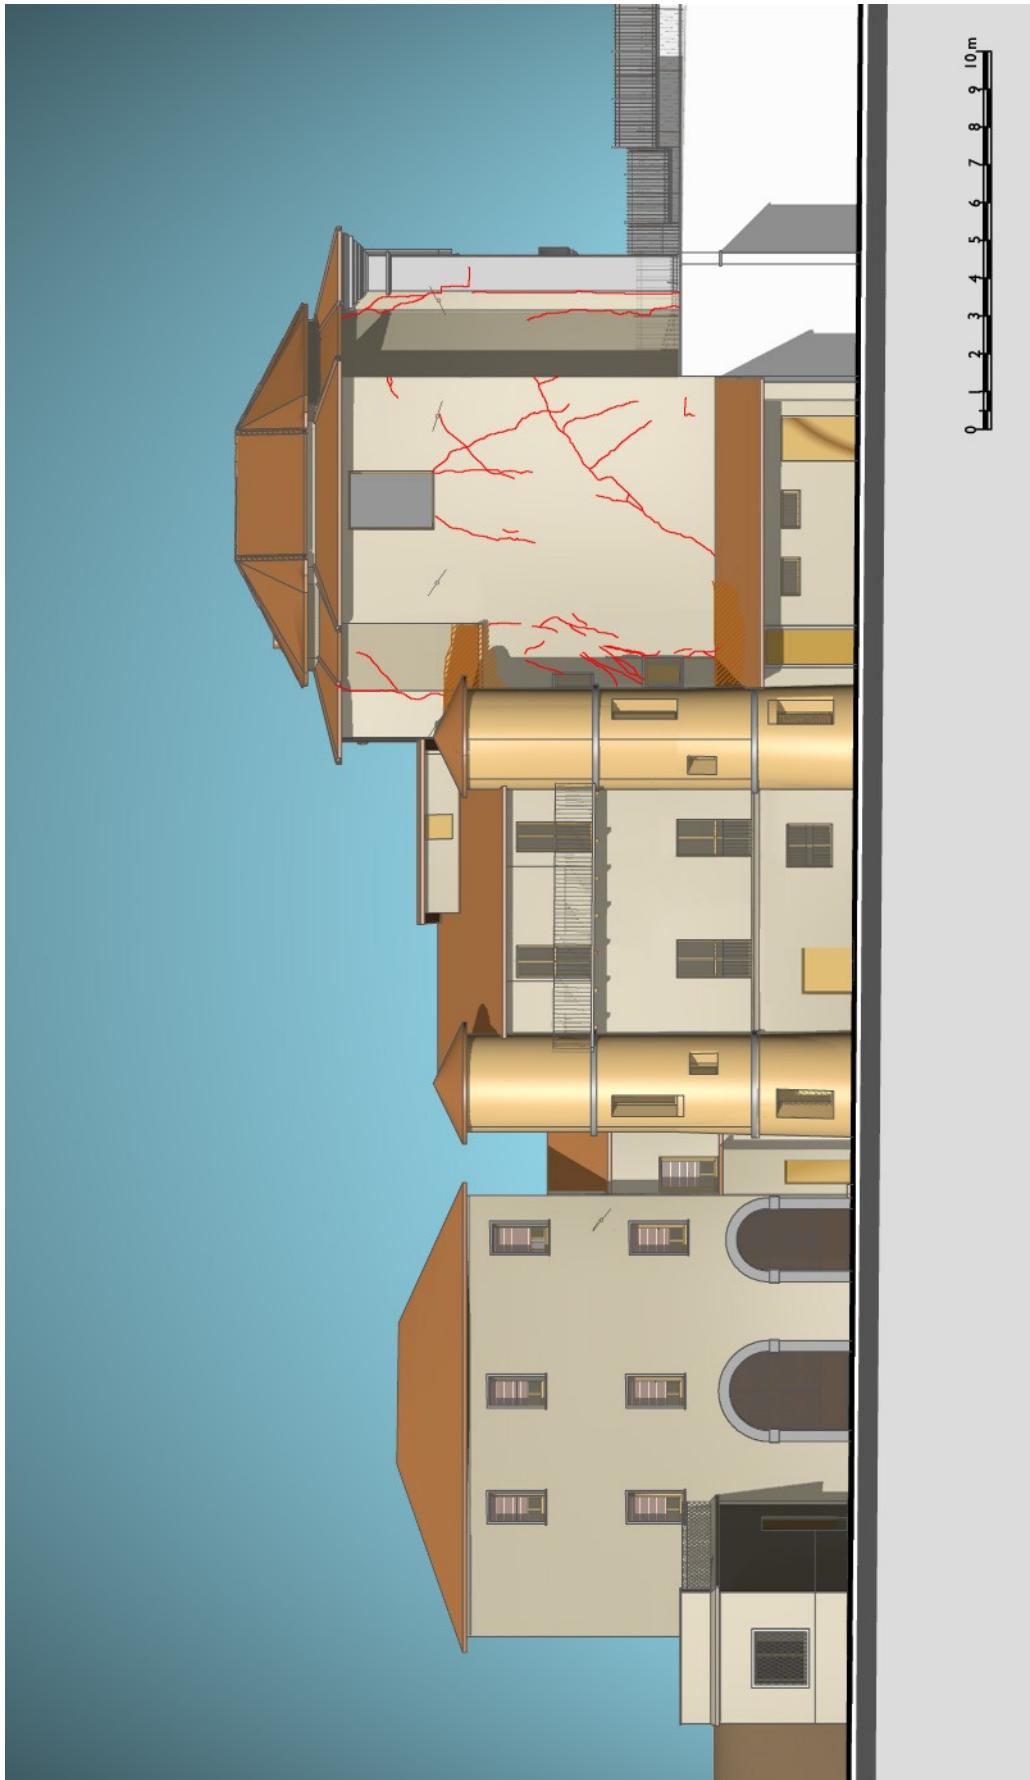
Sezione stradale del lato Sud (Rilievo: Il Cenacolo S.r.l.)
